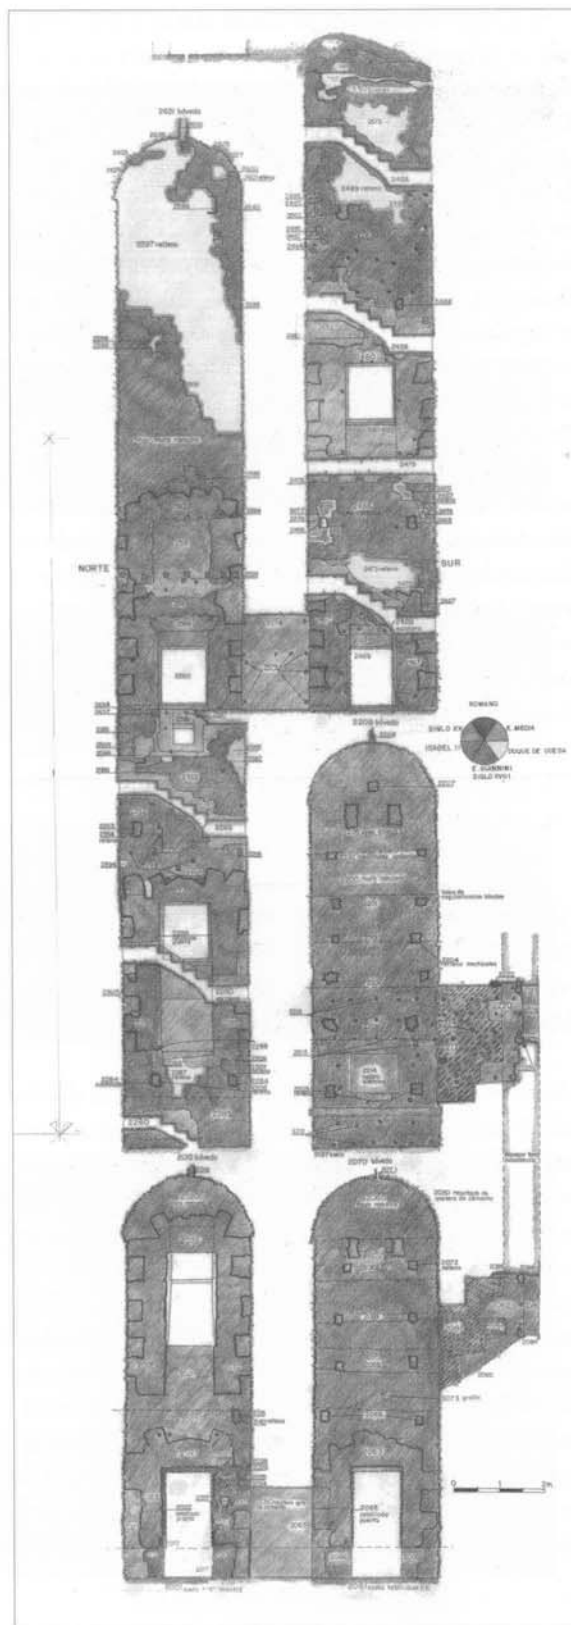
Interpretación de las fases de la construcción de la cara interior del muro de la fachada principal. P. Latorre y L. Caballero.
